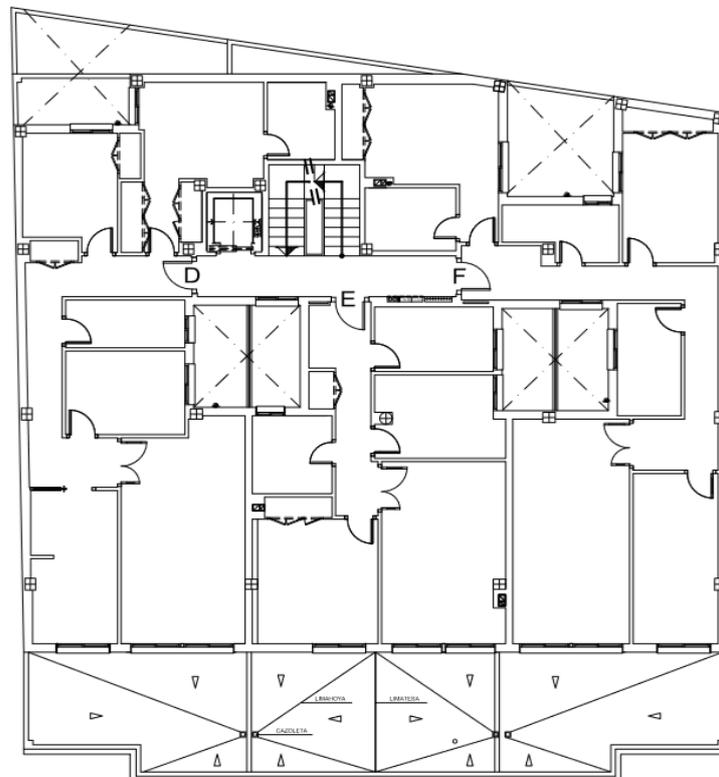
Planta Ático Edificio Pla de l'Arc, 2010.
